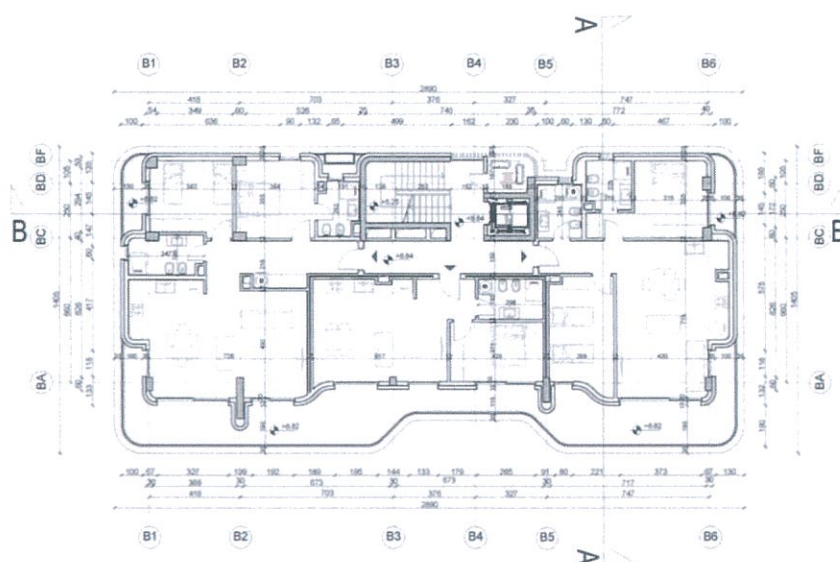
Planimetria e katit tip Banim (Objekti B+C).
